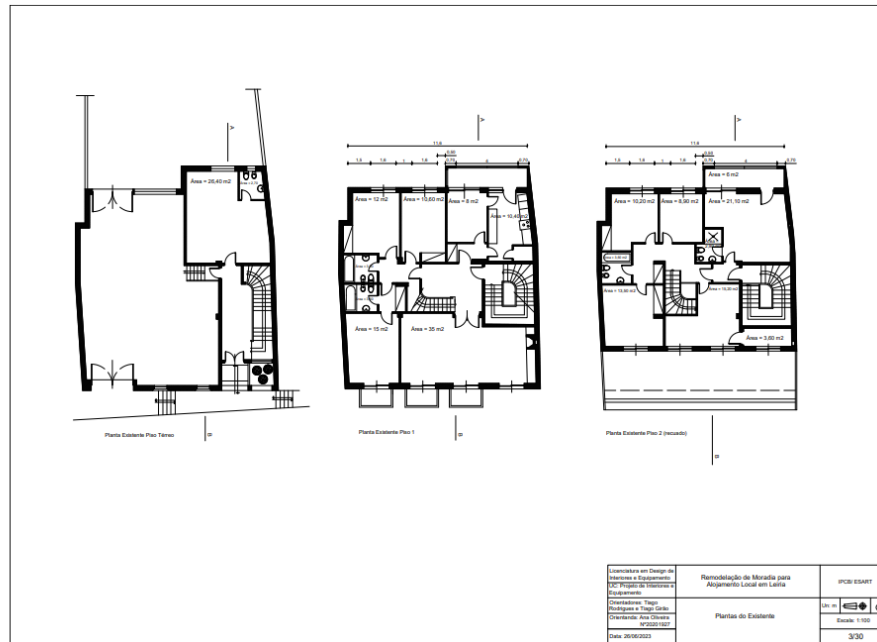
Plantas do Existente, Pisos Térreo, 1 e 2, fonte Câmara Municipal de Leiria
